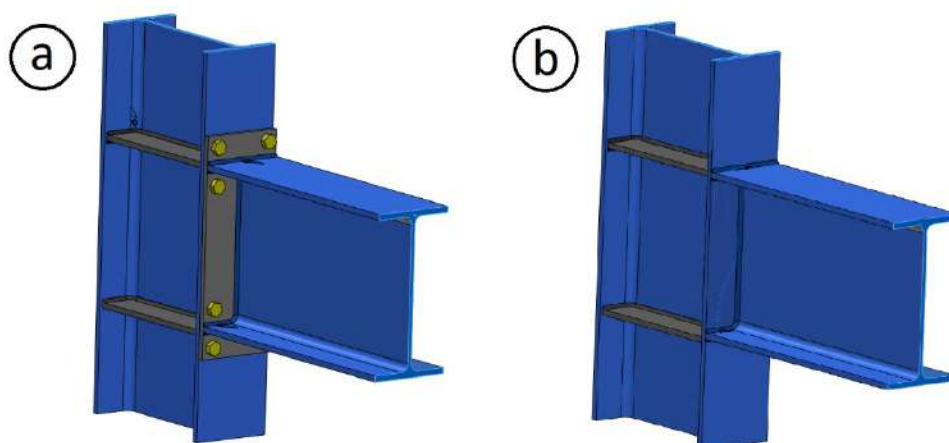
a) Unión atornillada. b) Unión soldada.
